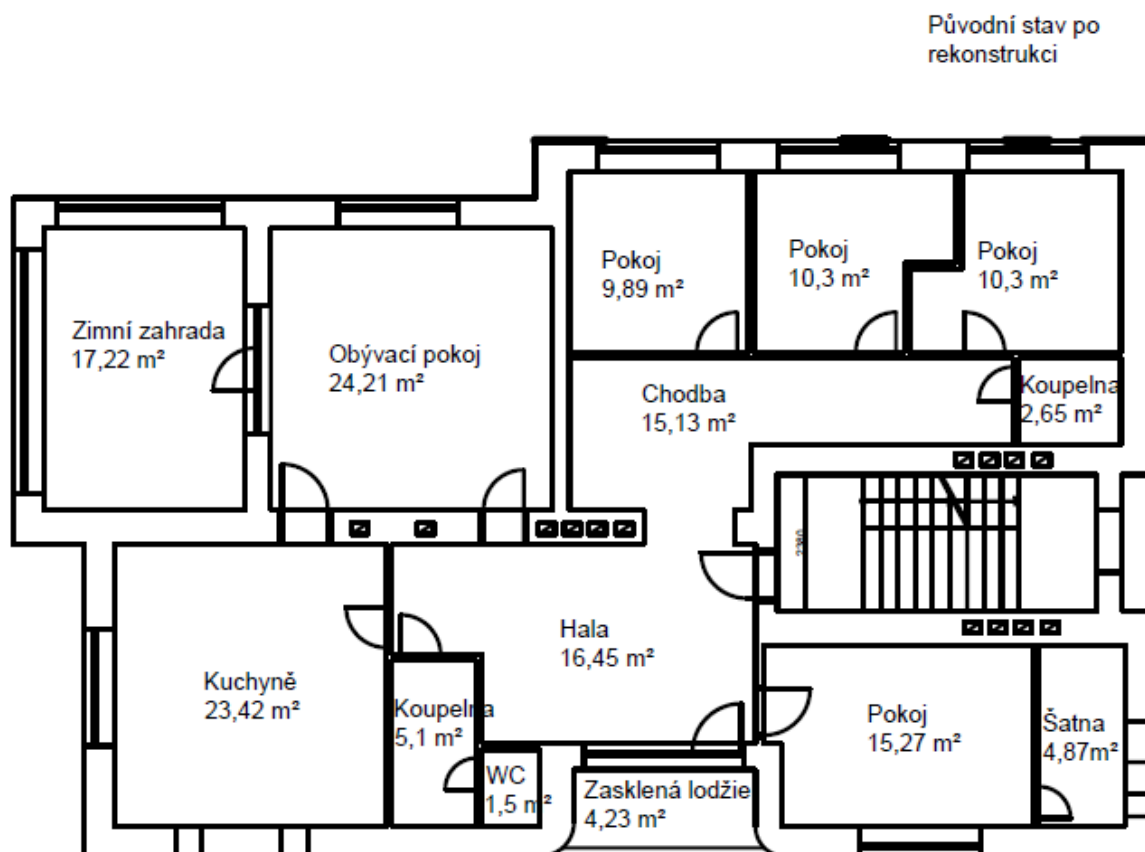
Půdorys 1.NP-původní stav, (nákres autor)
